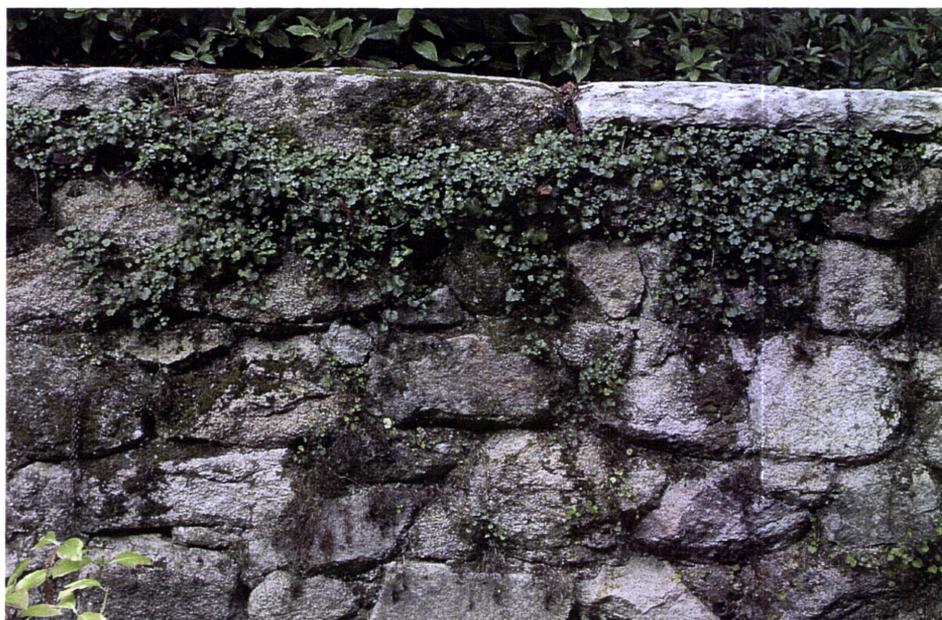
Muro de suporte com alvenaria de pedra à vista e infestado de plantas superiores
